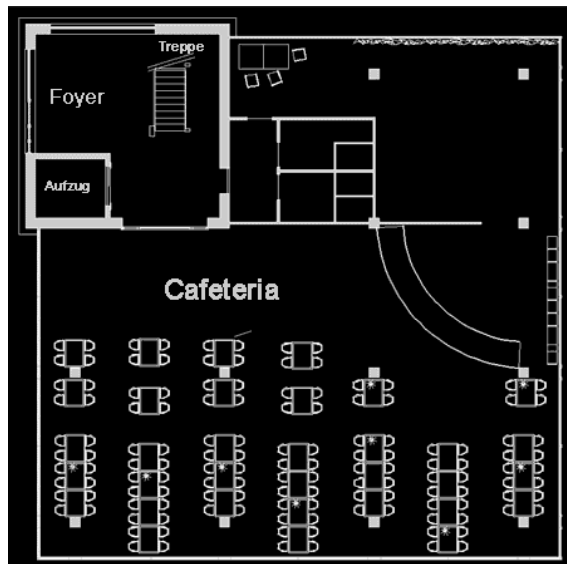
Grundriss Level 0: Cafeteria
